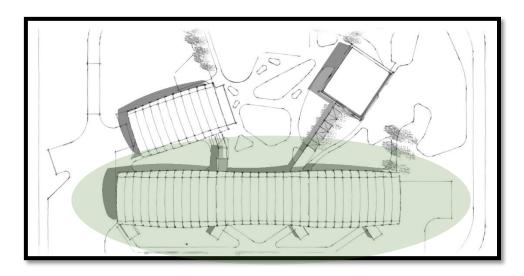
Ubicación de Planta Empacadora en el terreno. Fuente: Propia [Realizado el 10.12.2018]
